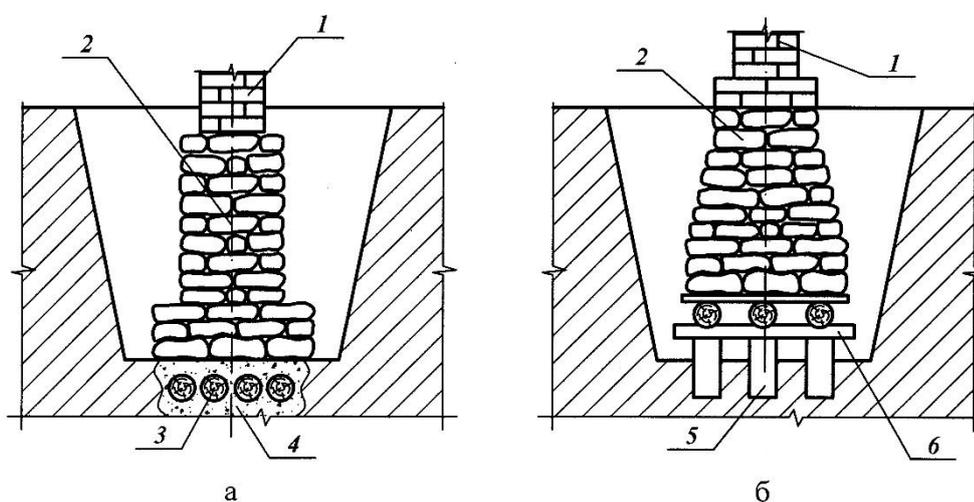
Традиционные конструкции фундаментов старых зданий: а – бутовый фундамент на естественном основании; б – фундамент на сваях; 1 – кирпичная кладка стен; 2 – бутовая кладка на растворе; 3 – деревянные лежни; 4 – каменная забутовка; 5 – деревянные сваи; 6 – деревянный ростверк
